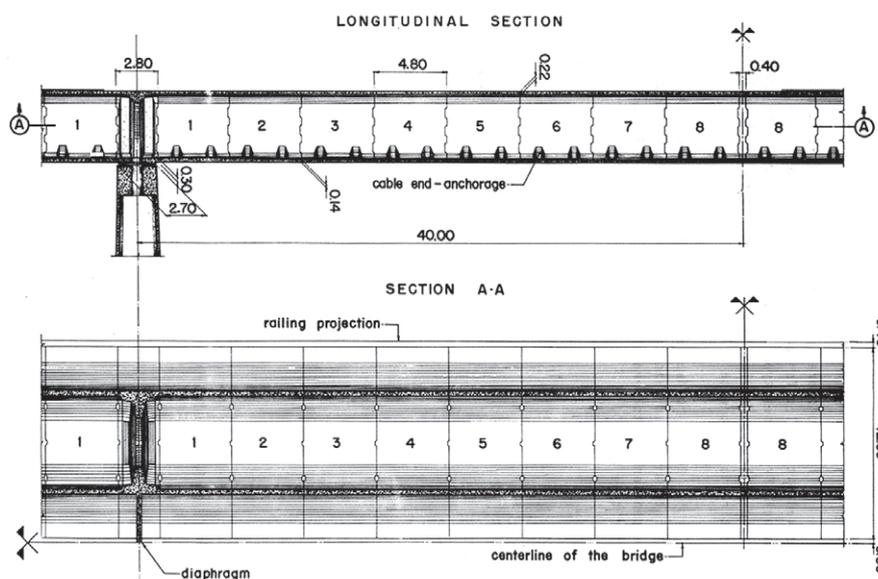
ELEVAÇÃO E PLANTA DA VIGA, MOSTRANDO AS 8 ADUELAS USUAIS POR BALANÇO E A ADUELA DE APOIO
